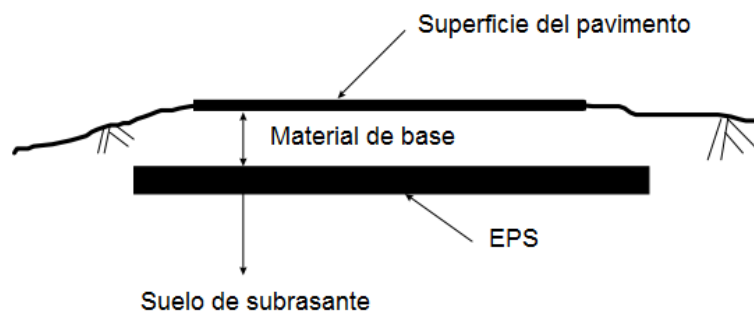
Sección esquemática de los componentes de un pavimento con aislamiento
